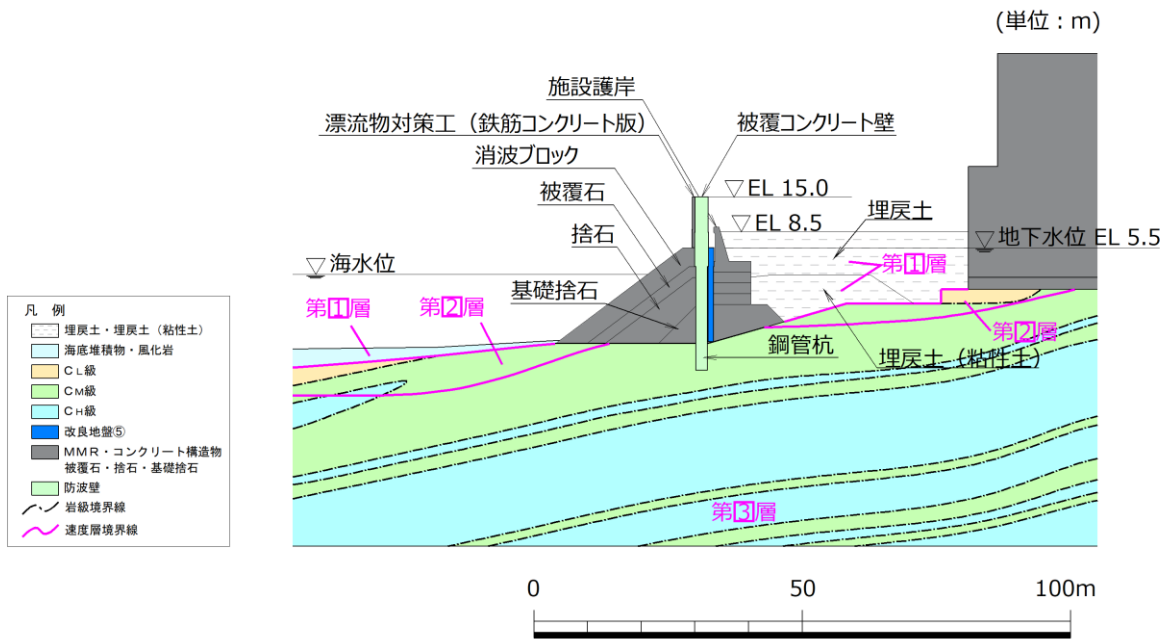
防波壁 (多重鋼管杭式擁壁) の横断面図 (③-③断面)
